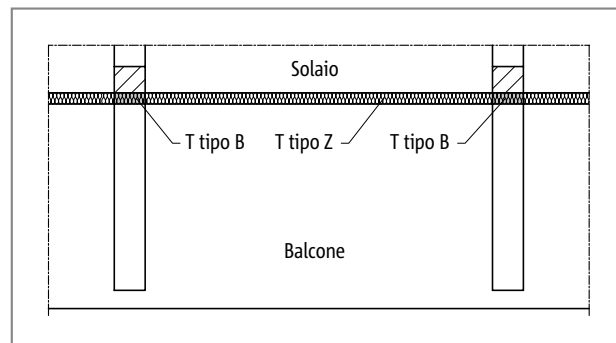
Schöck Isokorb® T tipo B: balcone con travi a sbalzo
